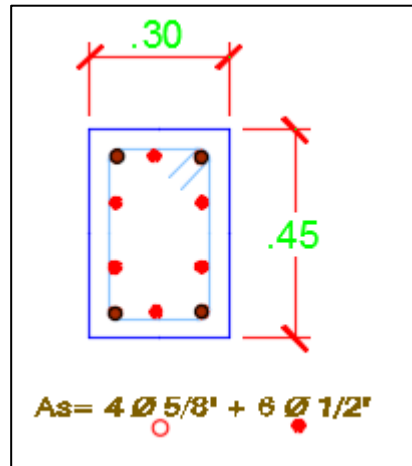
Sección Transversal Columna C-3 y-y. Fuente: Elaboración propia.
